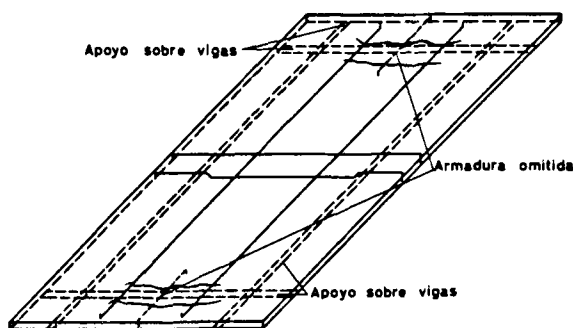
Grietas en una losa rectangular por omisión de armadura para absorber momentos negativos en un apoyo.
